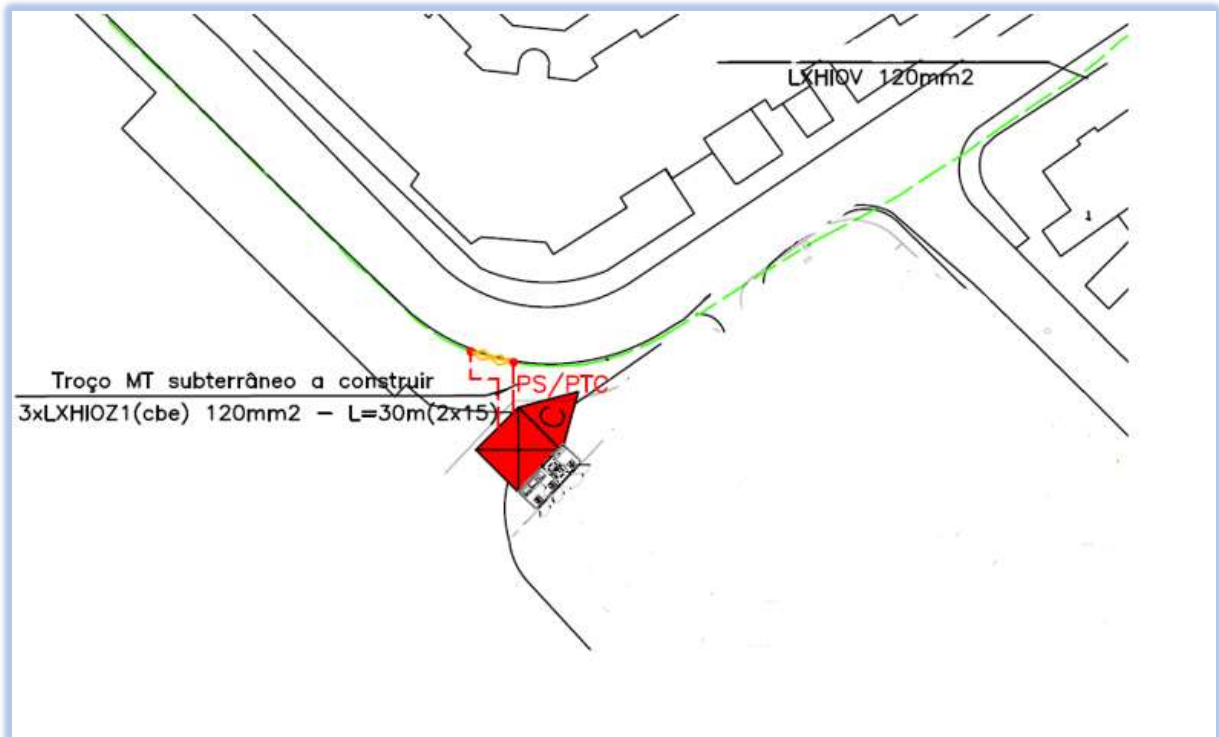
Traçado da rede existente, a desmontar e a construir para ligação do PTC.
